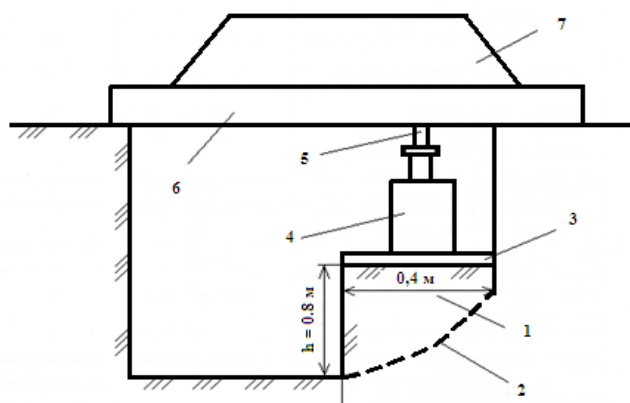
Схема установки для испытания целика грунта на сдвиге методом обрушения:
